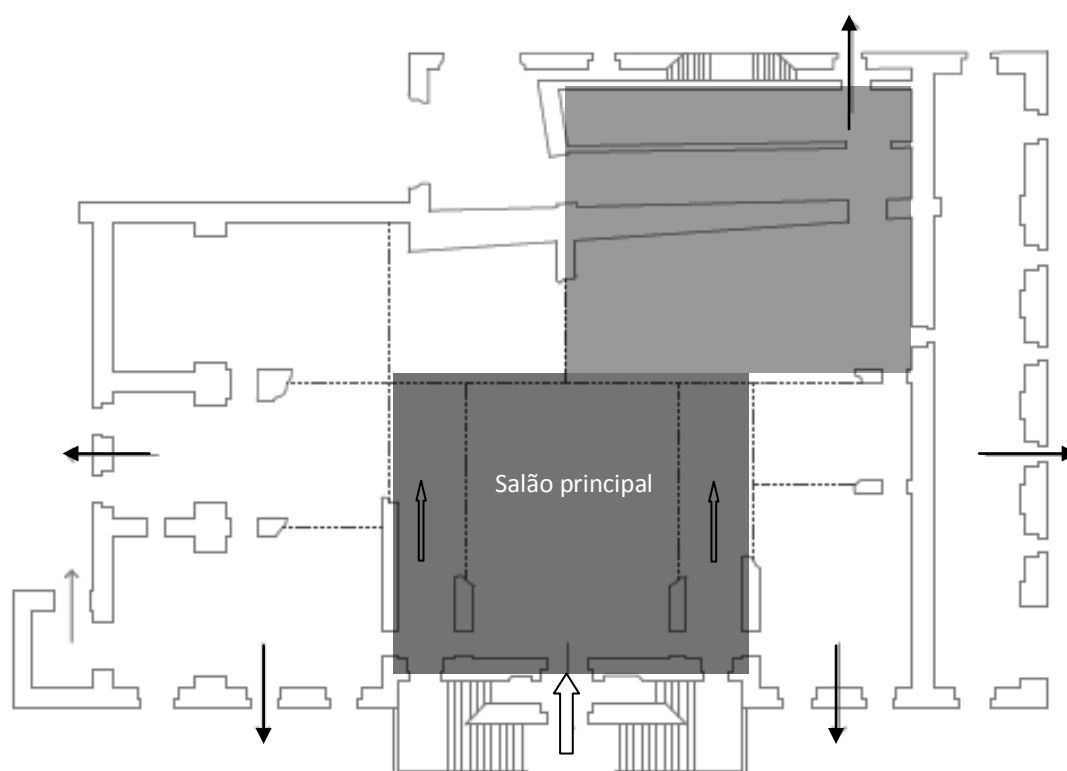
Planta de coberturas – marcação de eixos. (reconstrução a partir da planta, levantamento de 1988), fonte: desenho da autora.
